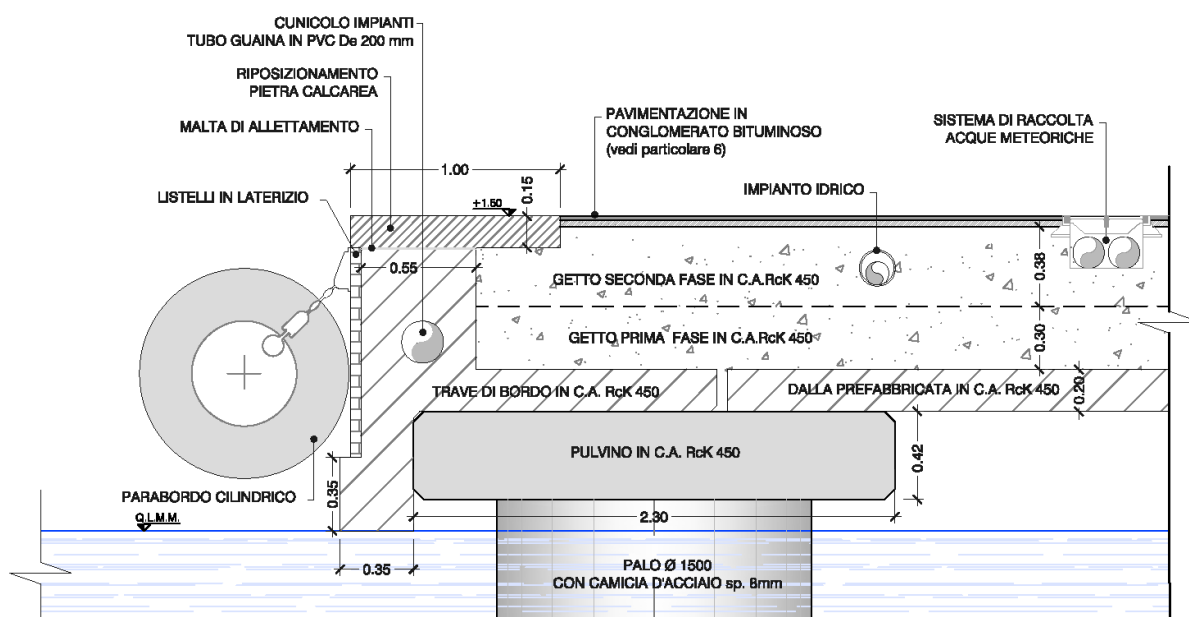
Banchina 13 – Sezione del bordo banchina in progetto
